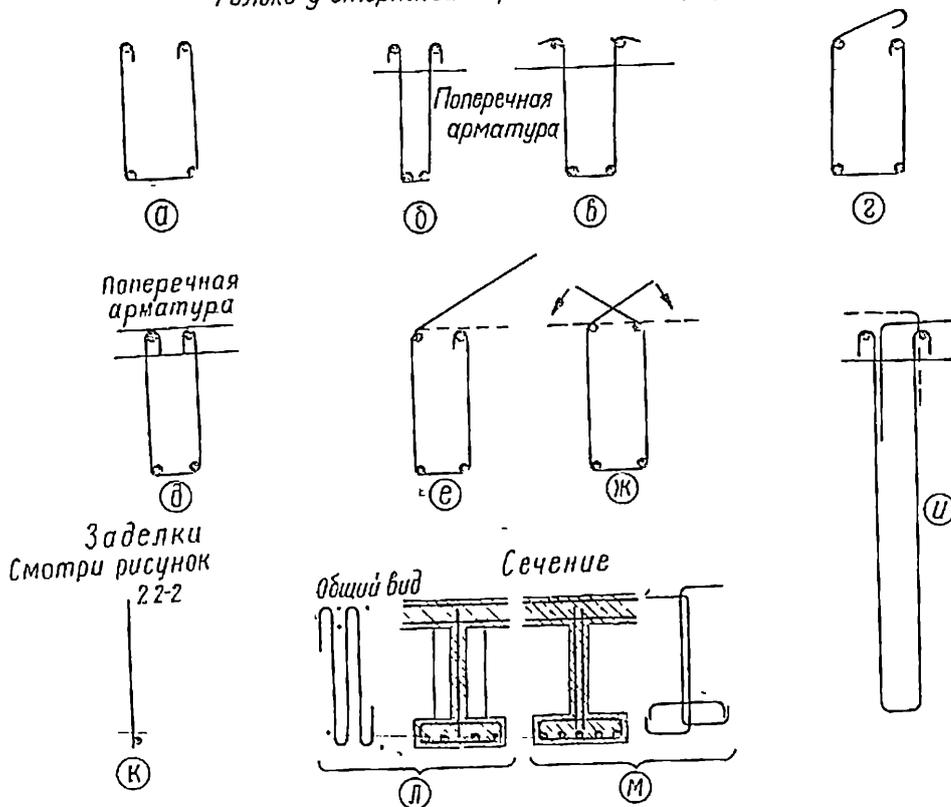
I. Вверху хомуты должны быть надежно заанкерены на коротких участках, поэтому необходимы крюки как у гладких стержней, так и у стержней периодического профиля
